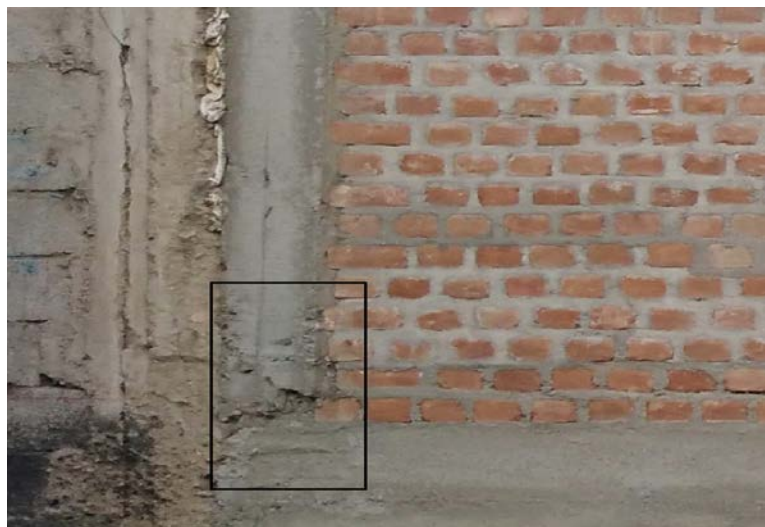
Presencia de grieta en union columna-muro - Muestra 08.
